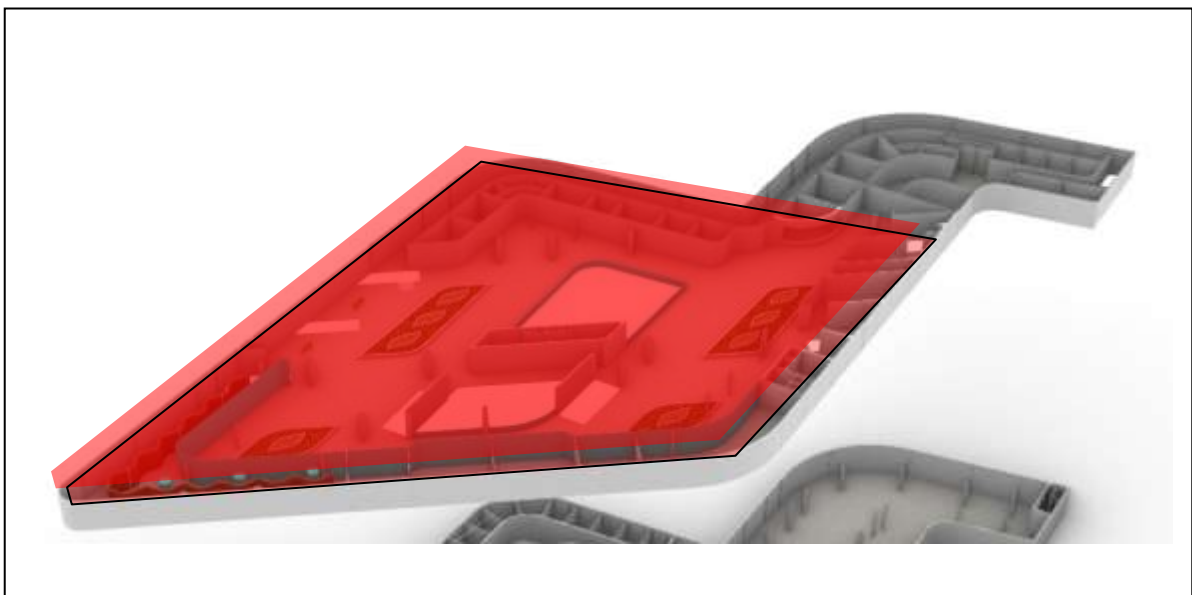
vue en plan sur les zones étudiier Source: Auteur
